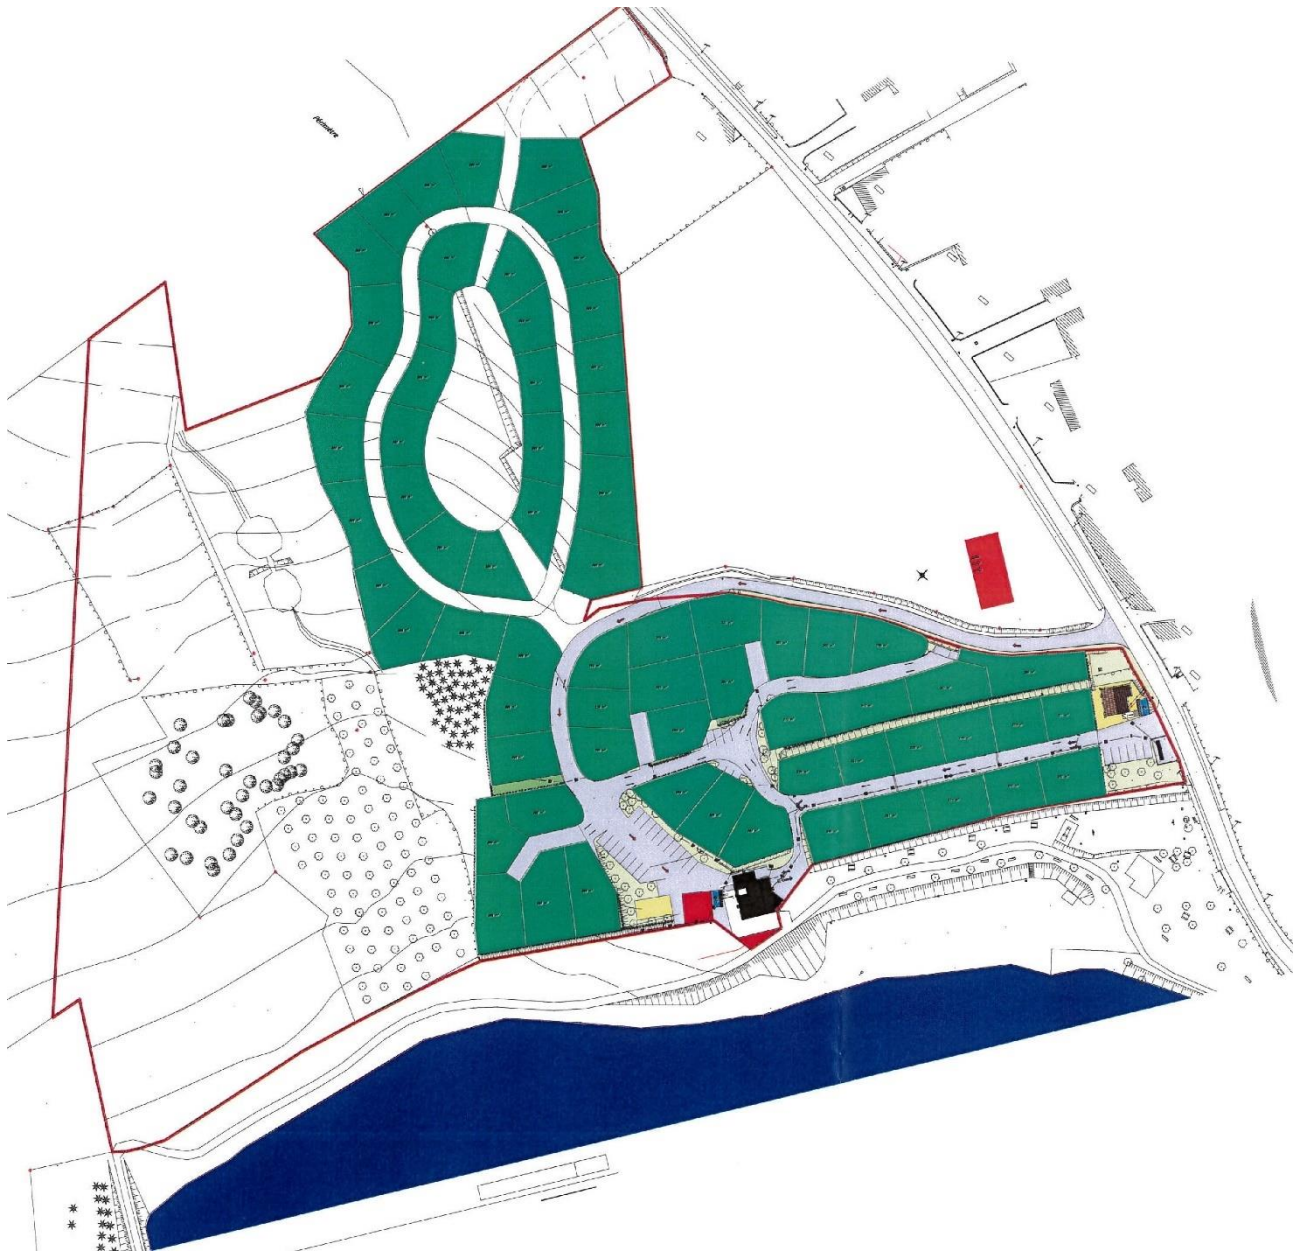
Plan d'aménagement : solution B2 (non retenue)
